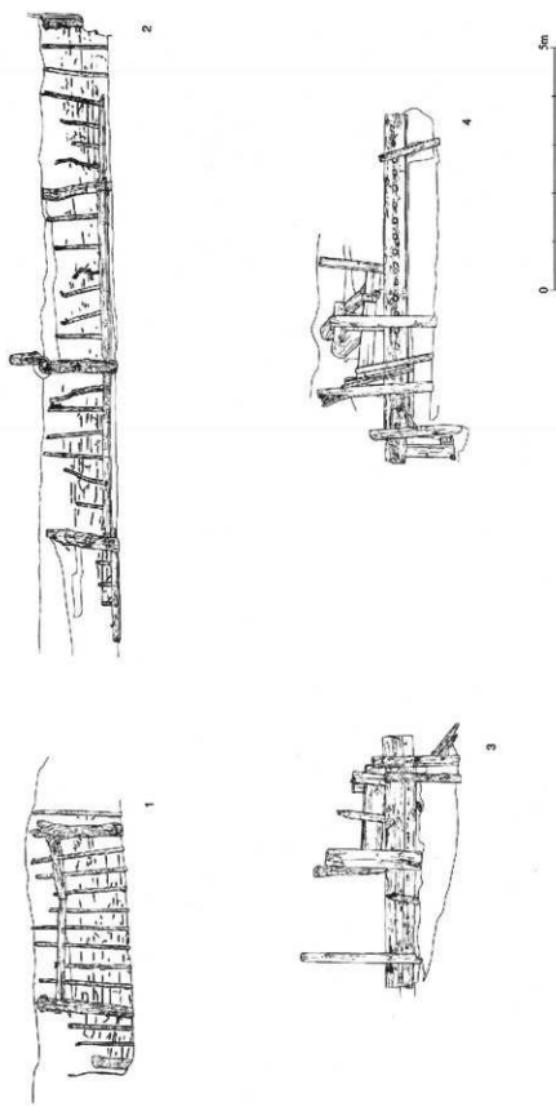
西橋造木製枠工・層板立面図 (S=1/100)
